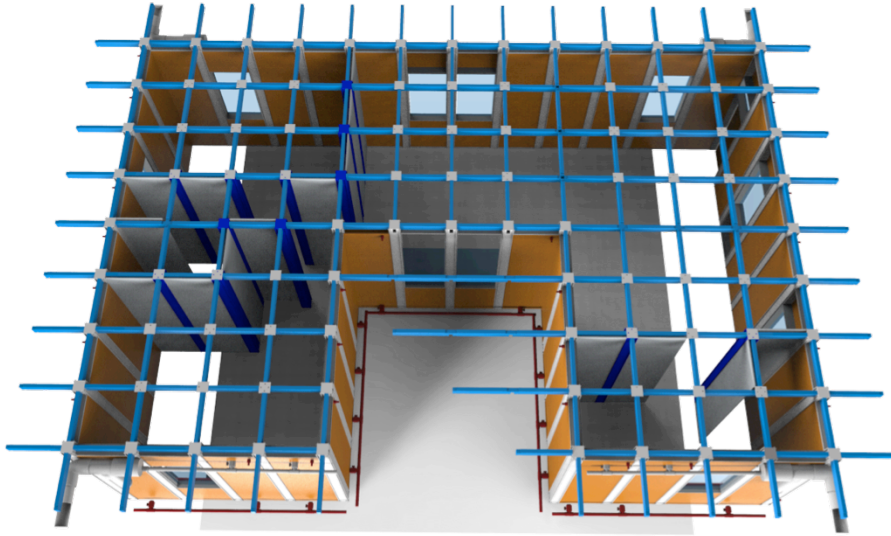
Vista de la Casa muestra sin Losa de techo; se aprecian las paredes internas en color gris y los pilares en azul.
